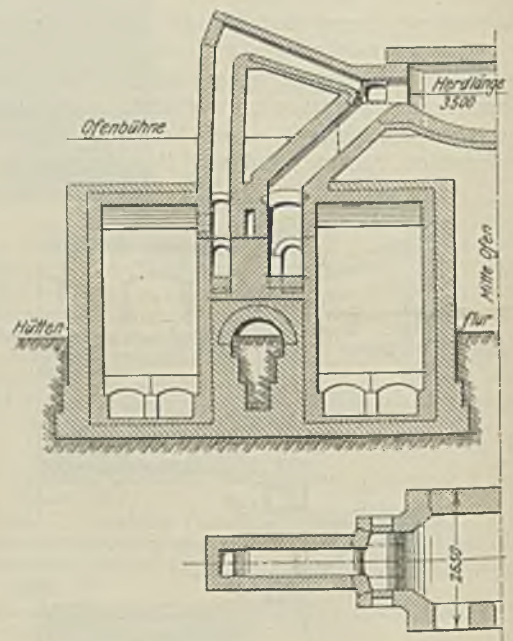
und 6. Längsschnitt und Grundriß des Ofens nach dem Umbau.
